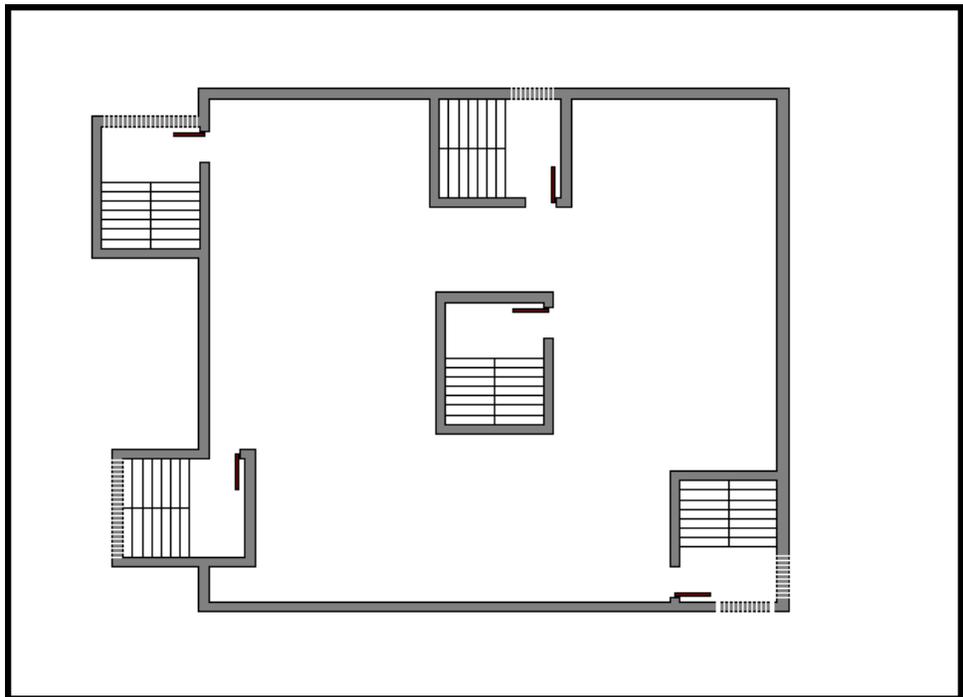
ZONAS VERTICALES VENTILADAS E INTERIORES
